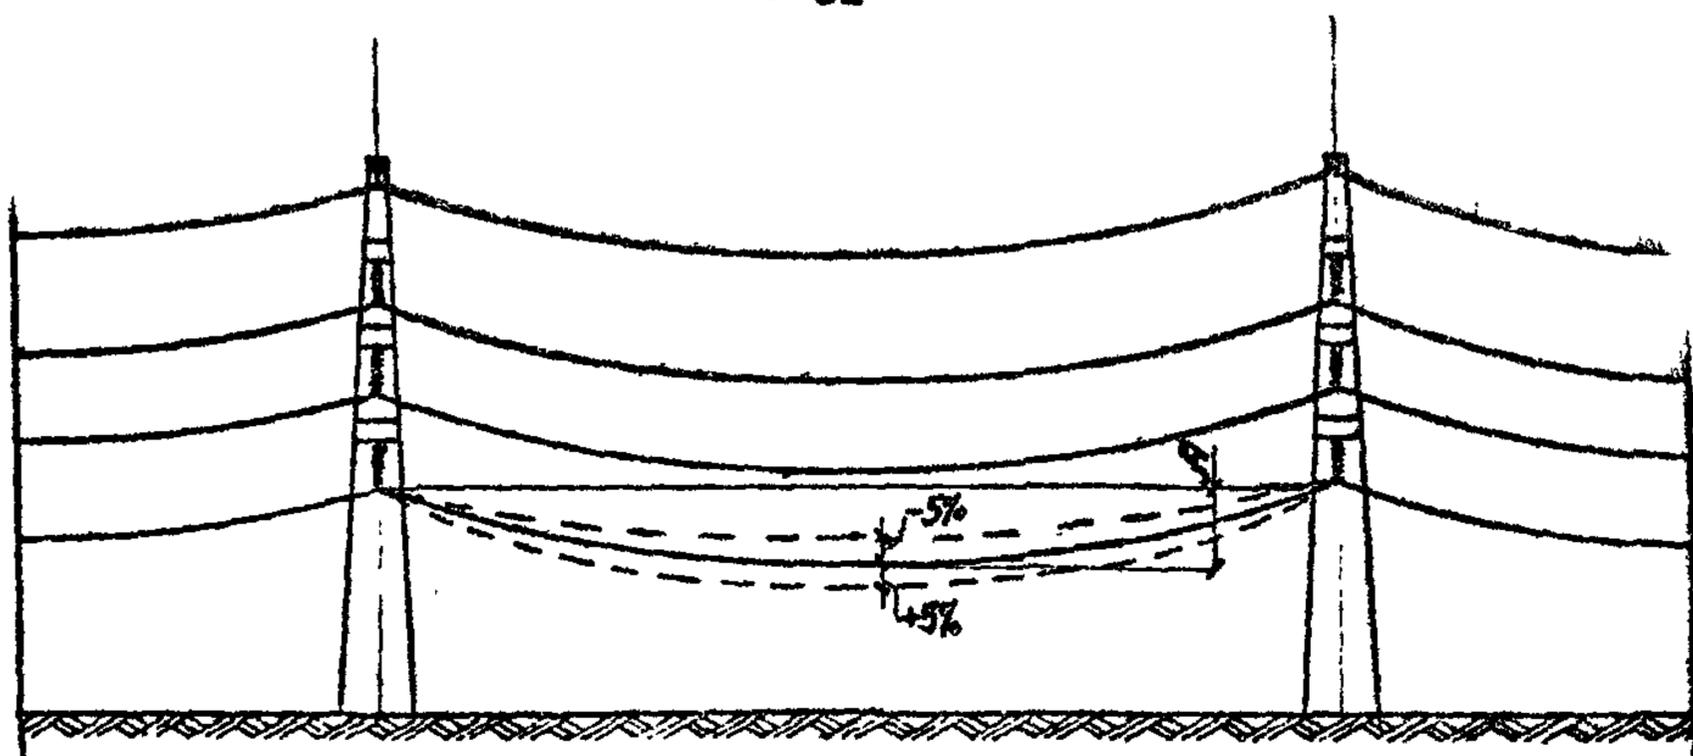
Нормы и допуски на монтаж проводов.
